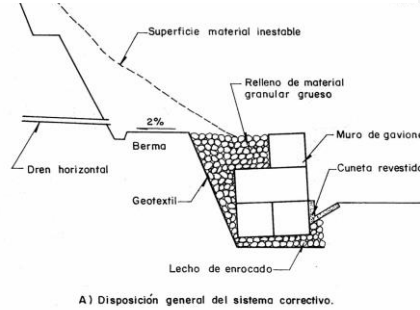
Detalle de muro de gaviones con relleno granular y corte del terreno y su respectivo drenaje. (García López, 2014)
